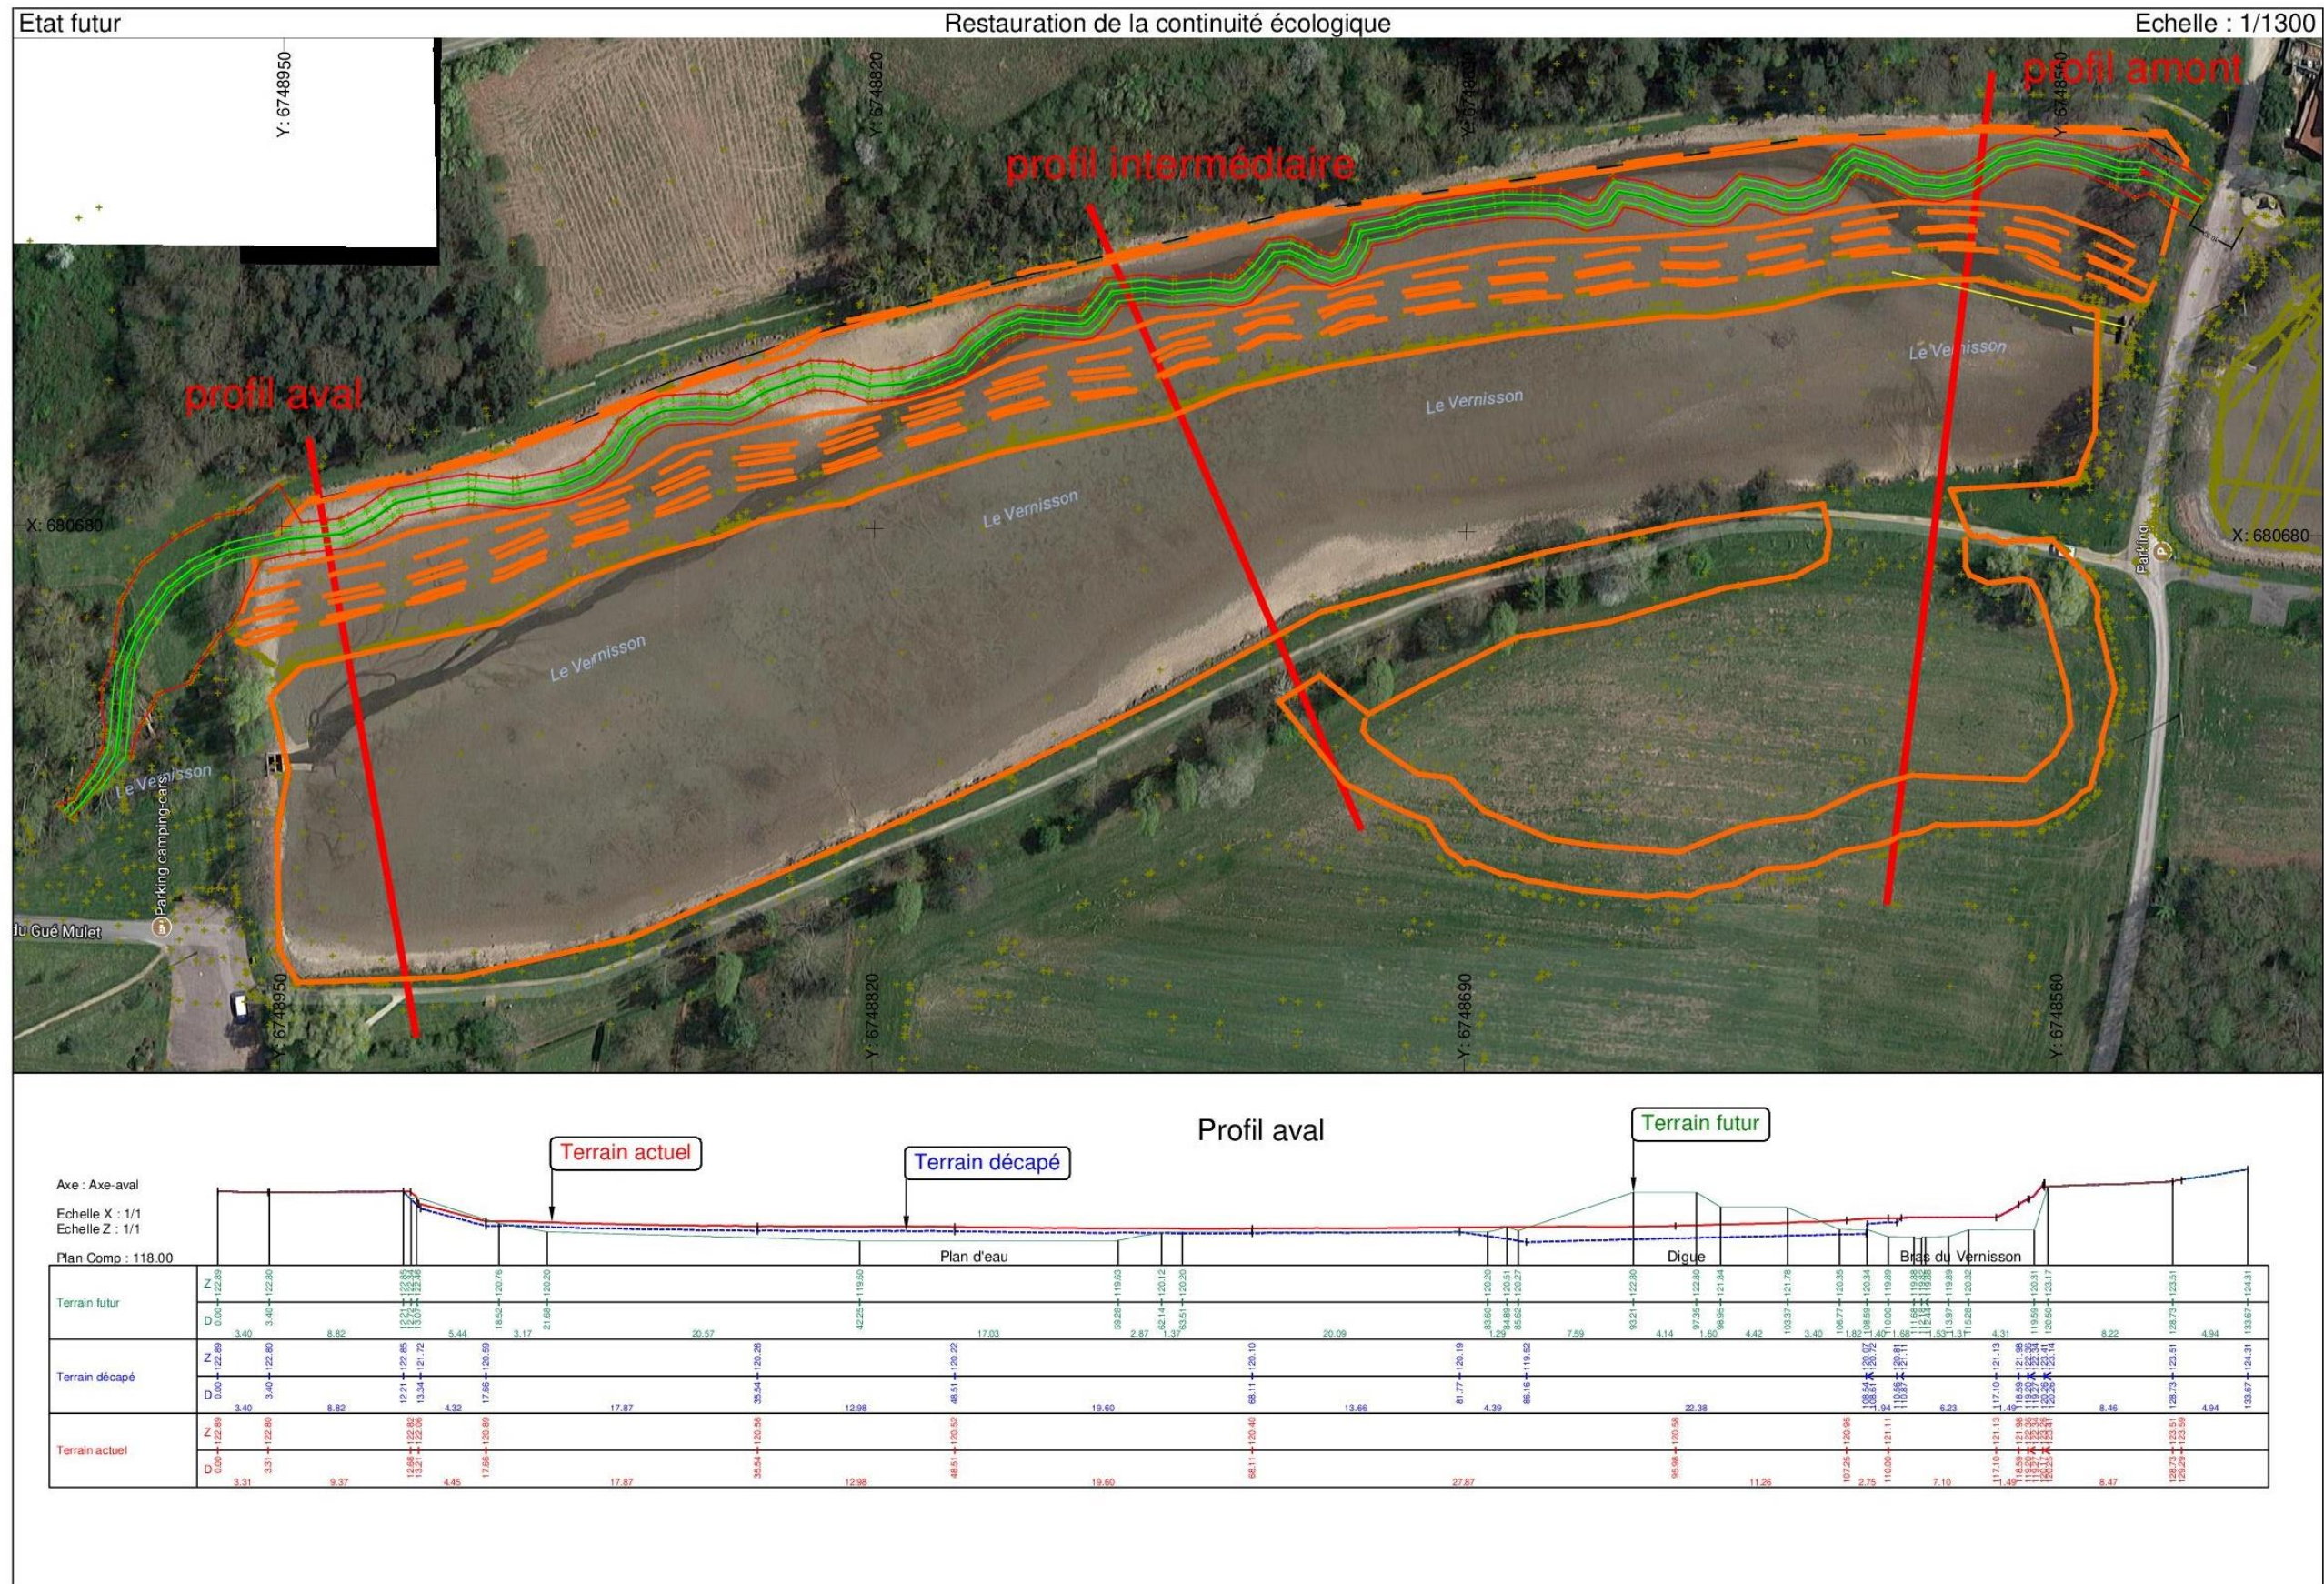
Etat futur : Plan d'eau aval - Profil en travers aval
